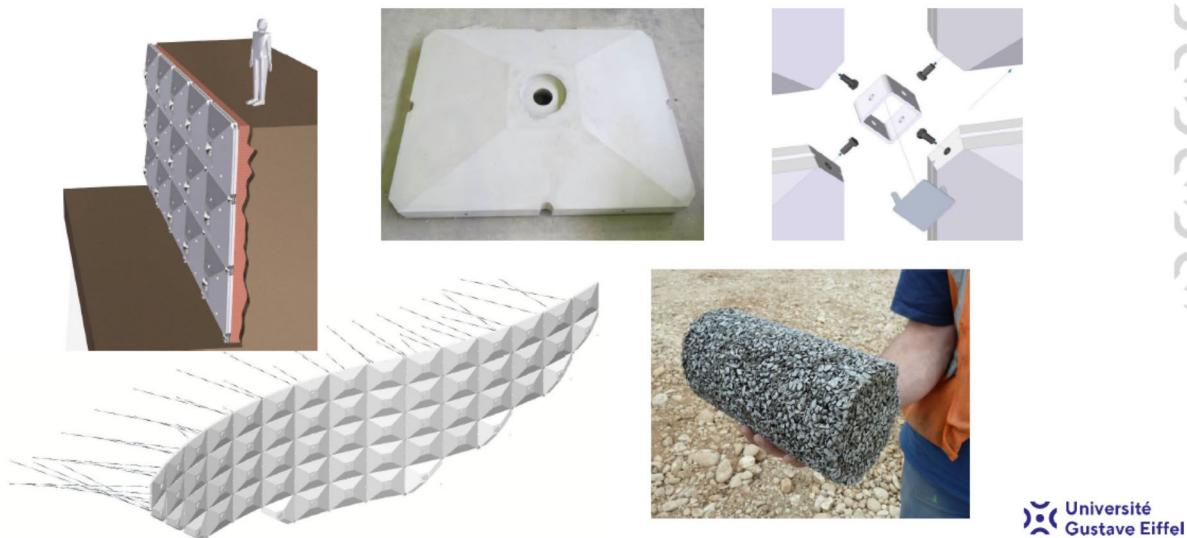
プレキャストコンクリート板とネーリングによる道路の復旧（フランス）
